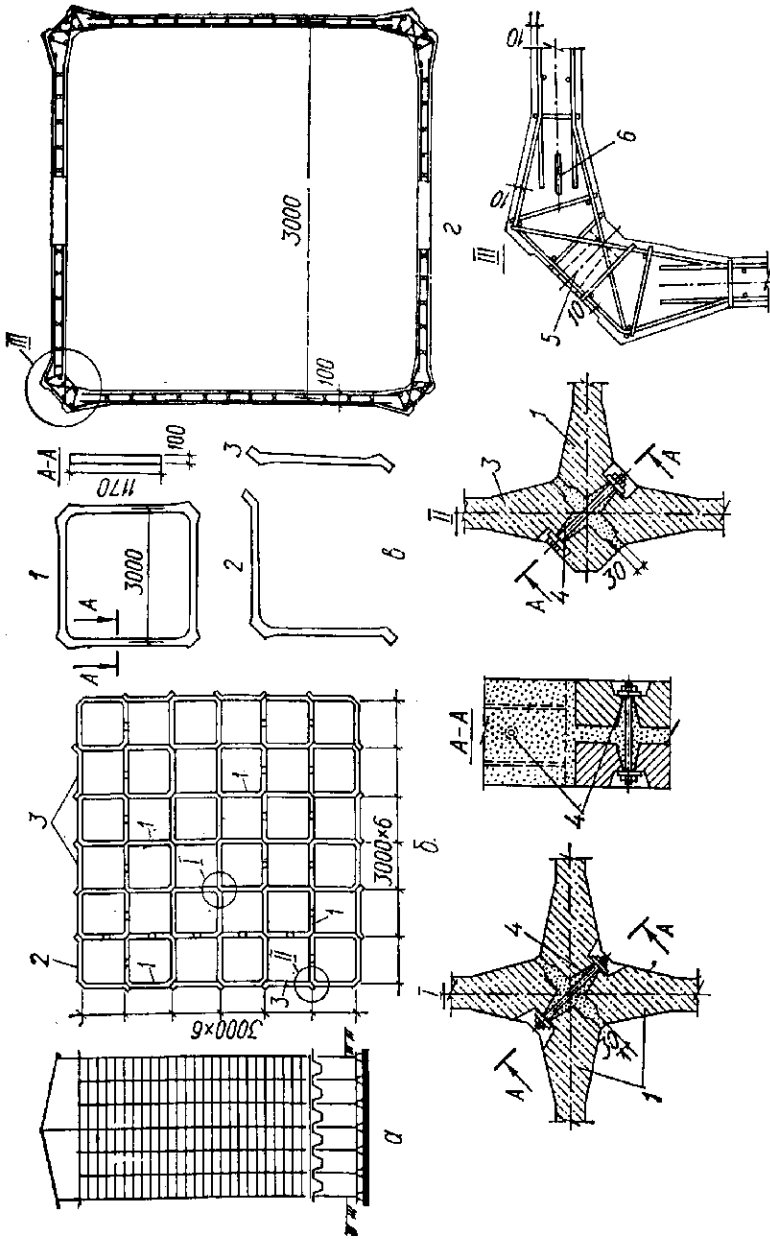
Конструкція збірних прямокутних силосів: *a* – поперечний розріз; *б* – план компонування силосу; *в* – типорозміри збірних елементів; *г* – об’ємний блок прямокутного силосу з гладенькими стінами; 1 – об’ємний блок; 2 – кутовий елемент; 3 – плоска панель; 4 – 3’ еднувальні болти; 5 – отвори для болтів; 6 – монтажні петлі
